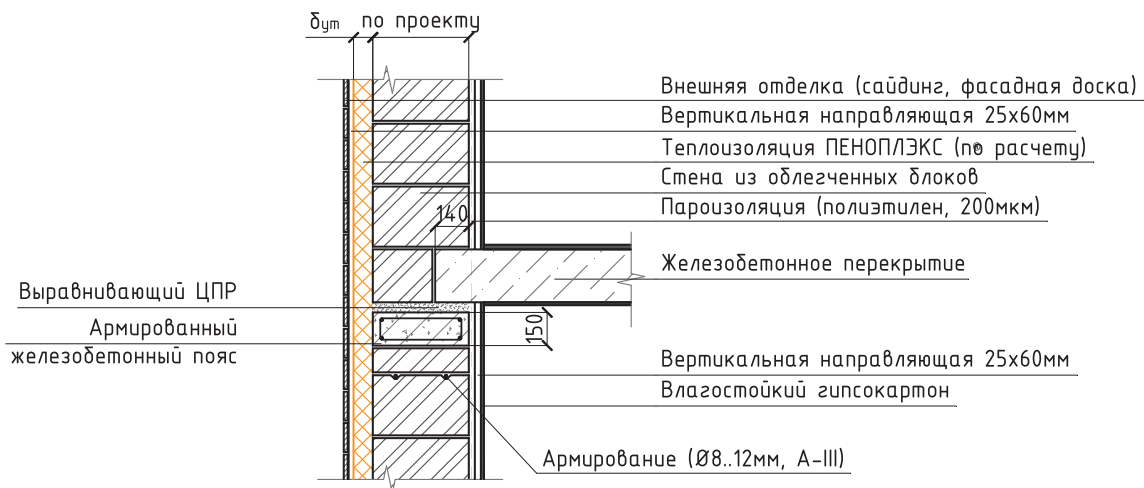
Схема сопряжения стены из облегченных блоков с железобетонным перекрытием (плиты ПЕНОПЛЭКС® снаружи).
